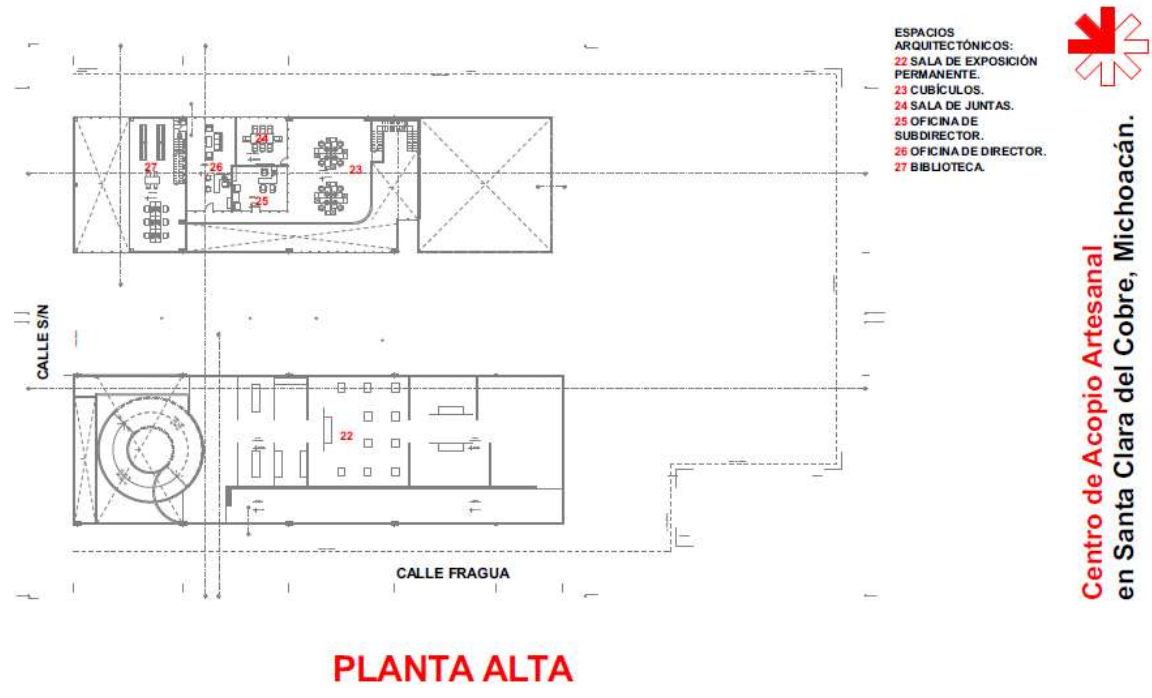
Planta alta del Centro de Acopio Artesanal. Elaboración: del autor. Fecha: 02/02/2017.
